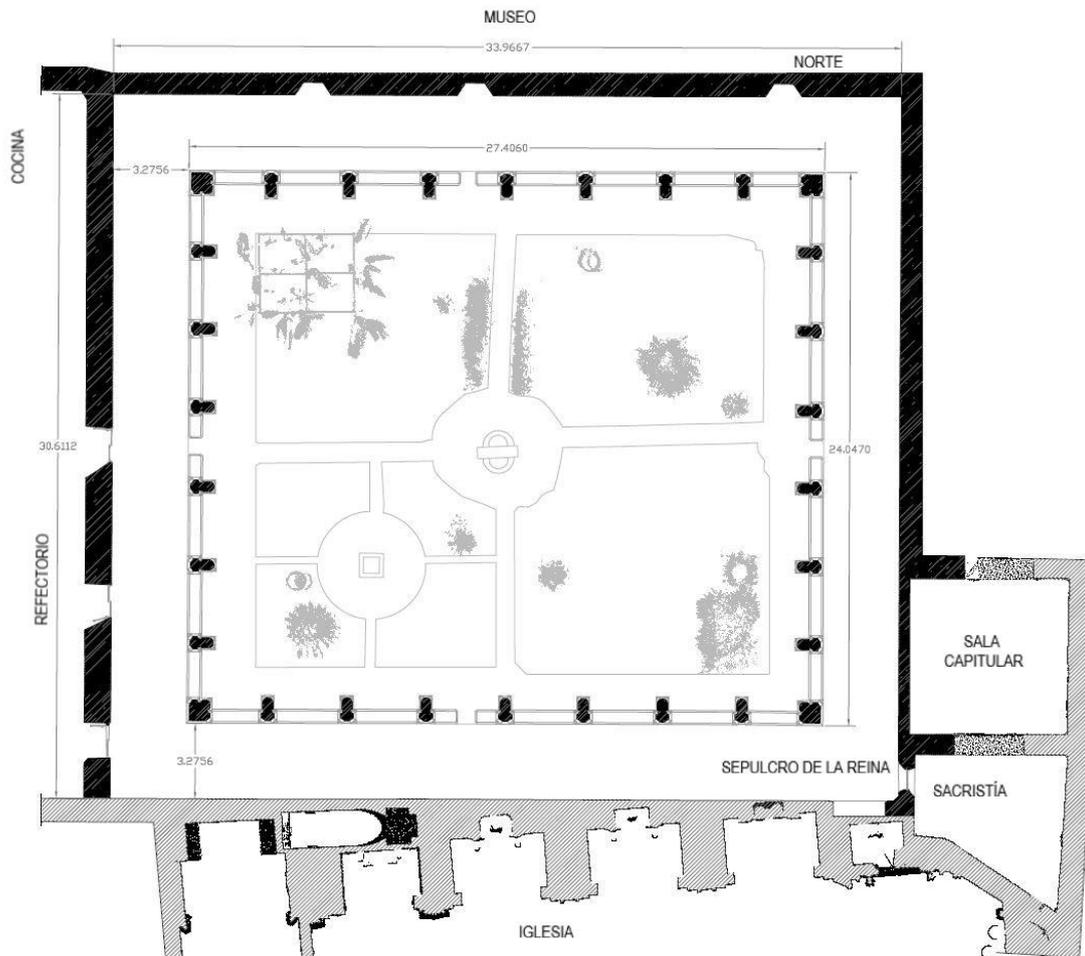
Plano de cotas generales de planta 2,00 y resumen de la distribución en planta baja.
